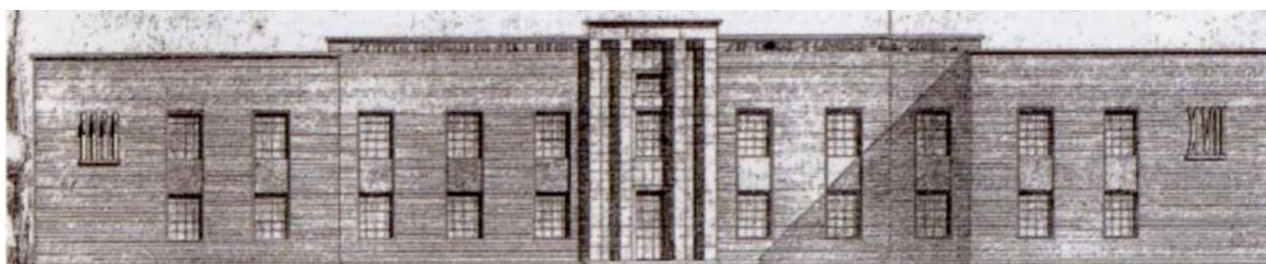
dettaglio del progetto originale – prospetto Ovest
